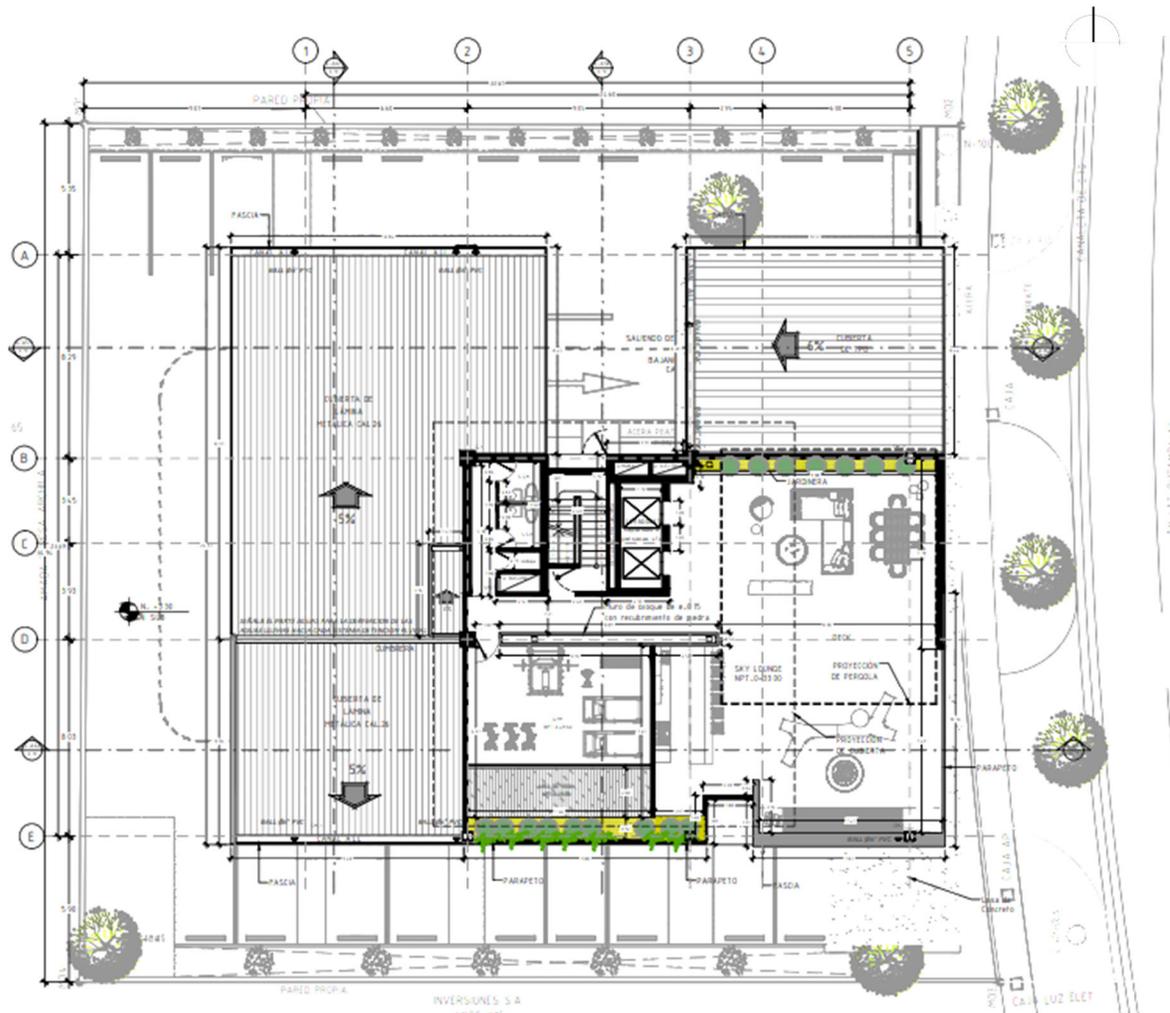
Planta Arquitectónica SKY-Lounge (Elaboración extraída de Plano A-9)
